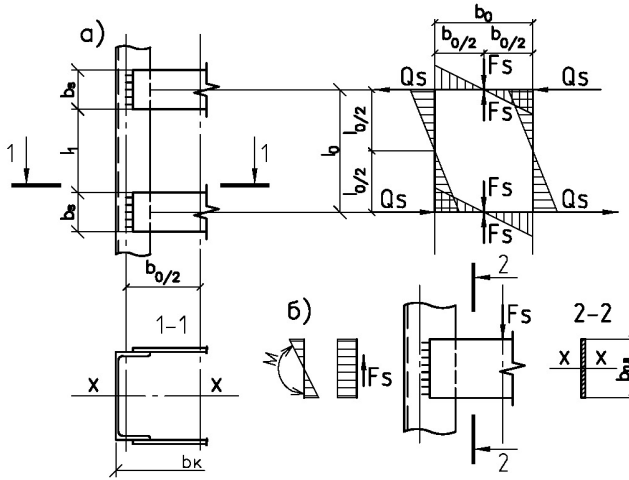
Розрахункові схеми наскрізної колони для розрахунку з'єднувальних планок: а– схеми для обчислення зусиль, б– вузол кріплення планки до гілки колони
